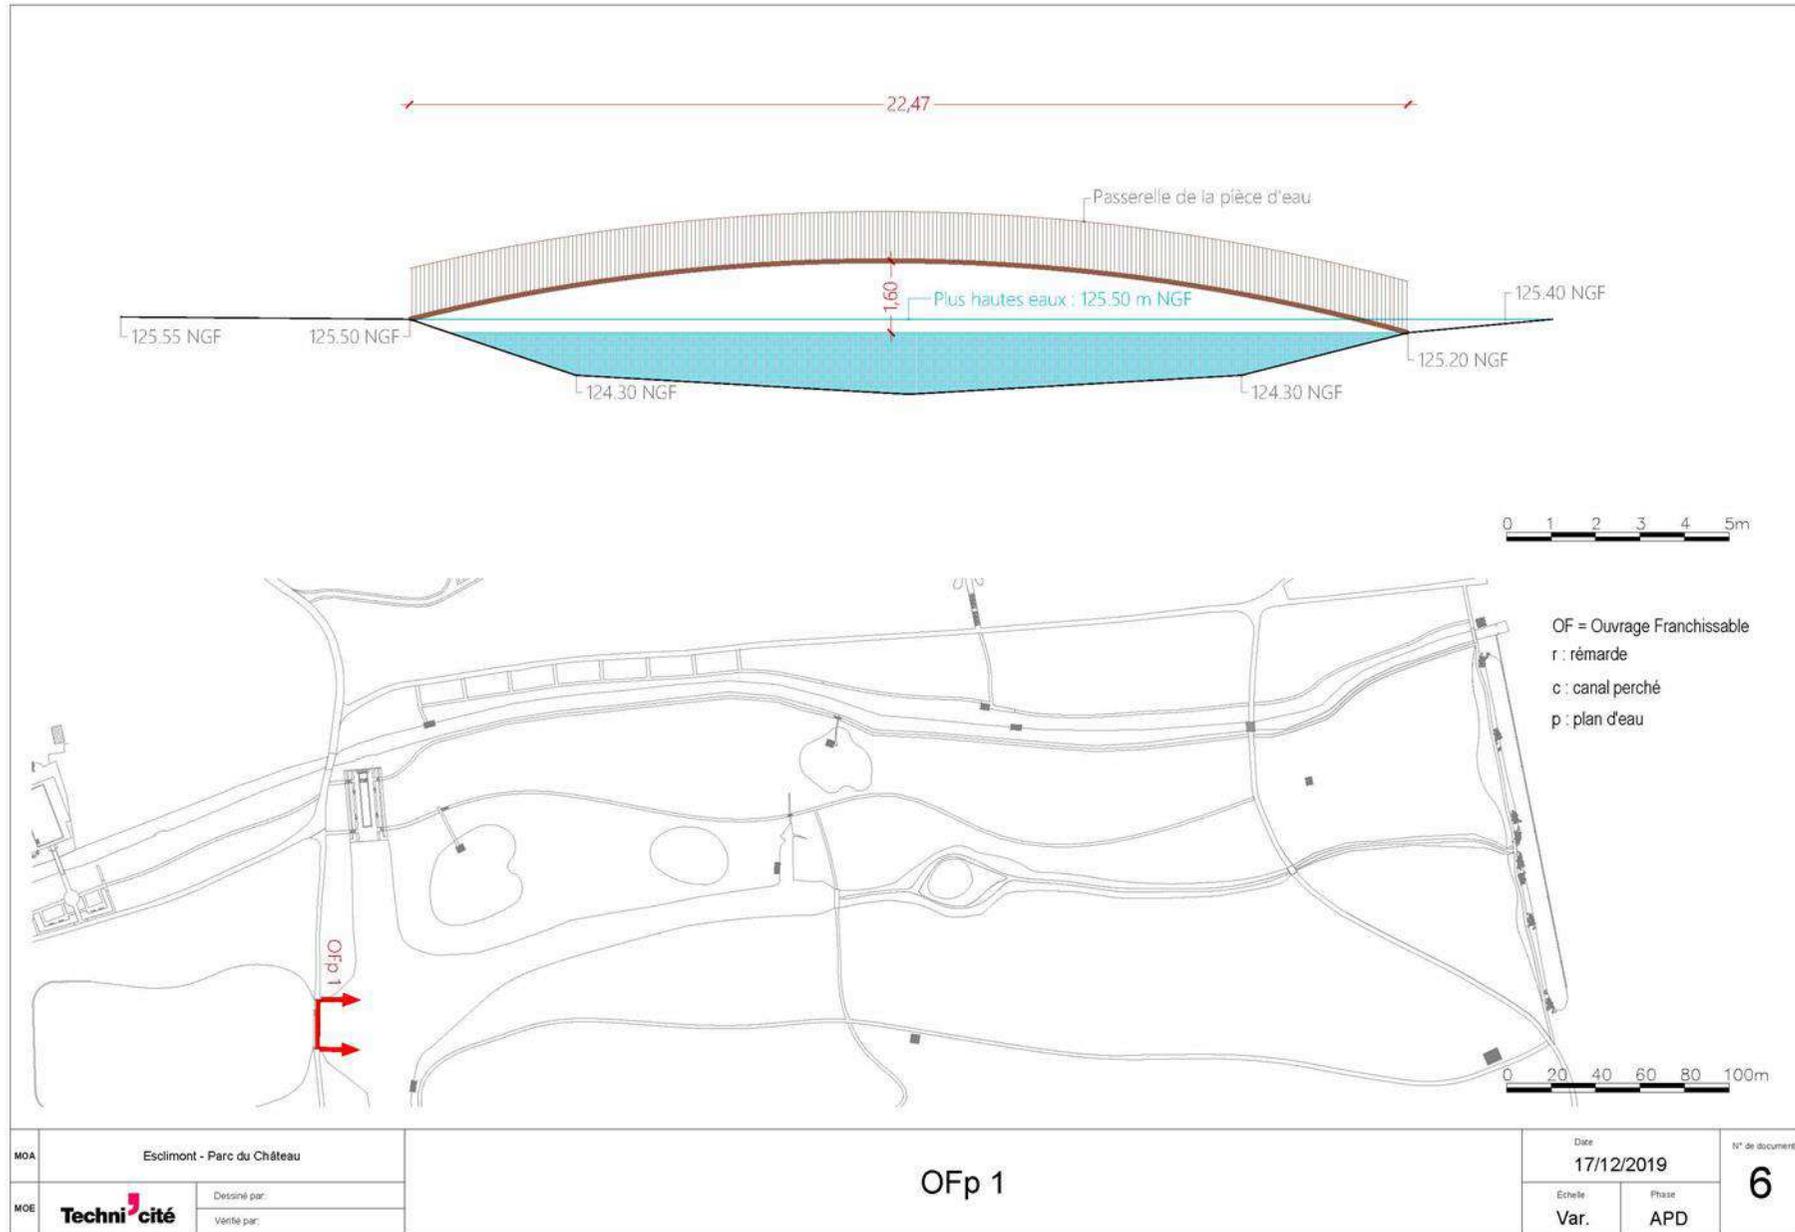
Coupe de la passerelle "du plan d'eau" OFp1
